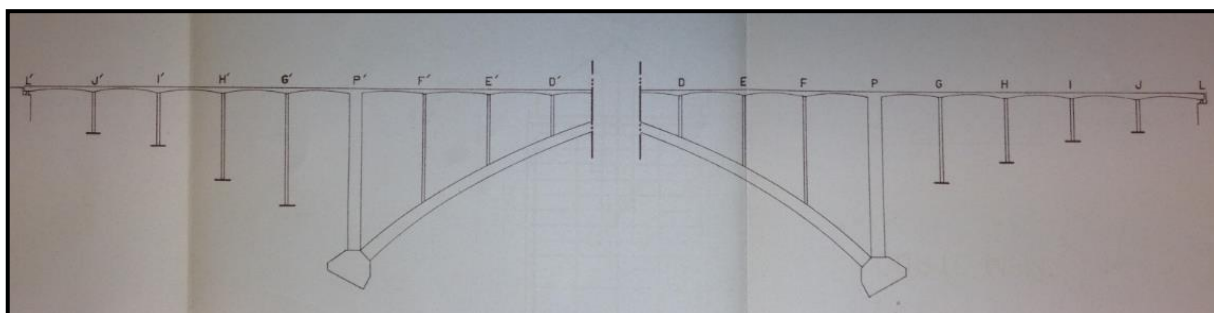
Eixos dos Pilares (MOP-JAE, 1963).
